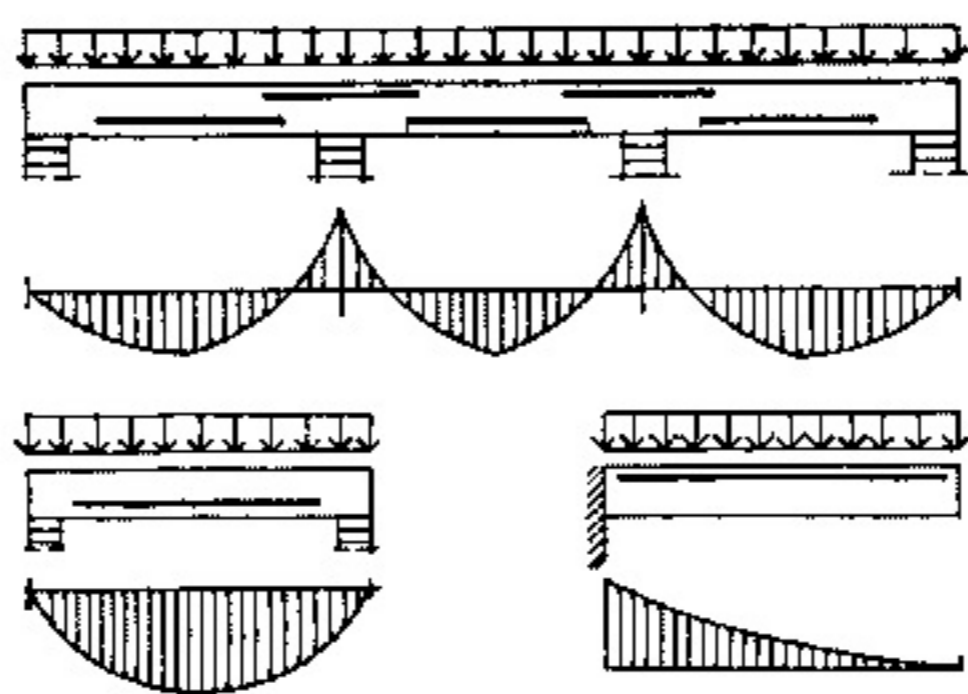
Armarea plășelor din beton după diagramele de momente încovoietoare
